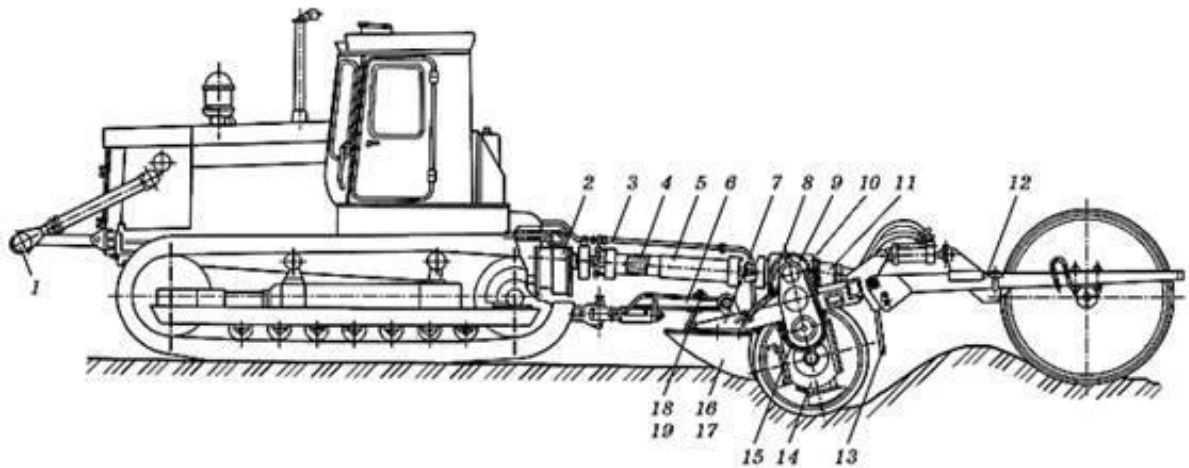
Конструктивна схема фрезерної машини МТП-44А:
